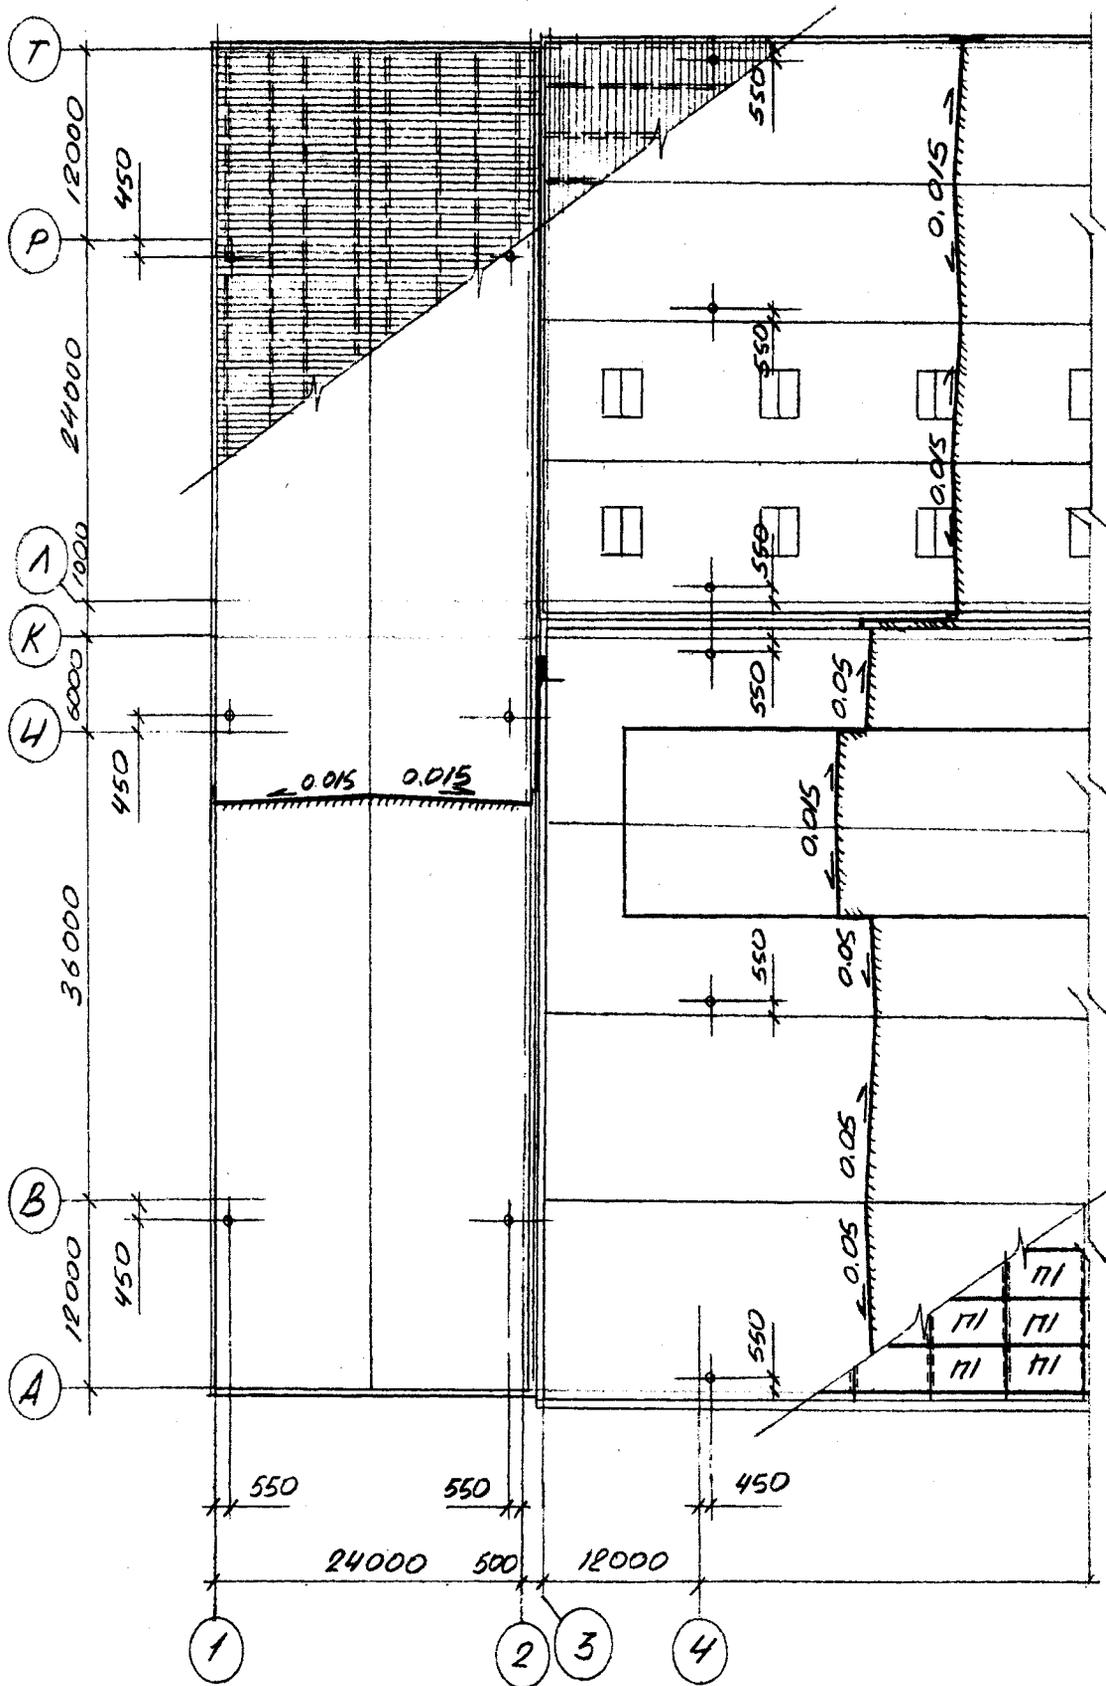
Пример выполнения фрагмента плана кровли и несуще-ограждающих конструкций покрытий
